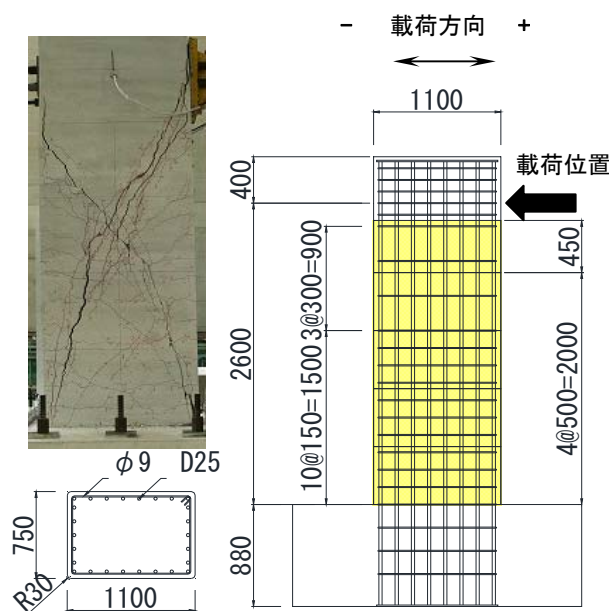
試験体寸法, 配筋および事前載荷時の損傷状況
